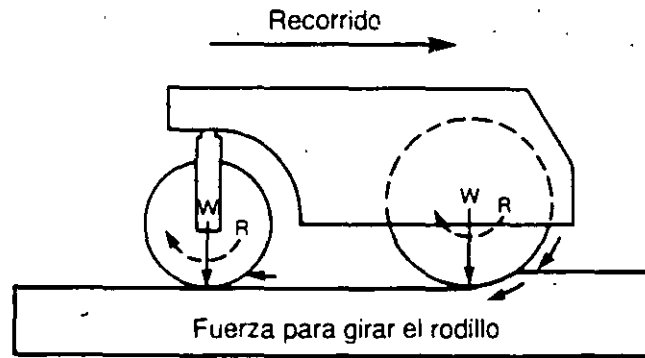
Dirección Correcta del Recorrido de la Compactadora.
